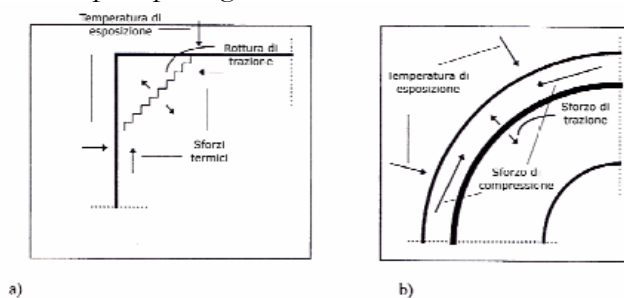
esempi di rotture per spalling: a) struttura ad angolo, b) struttura con superficie convessa
